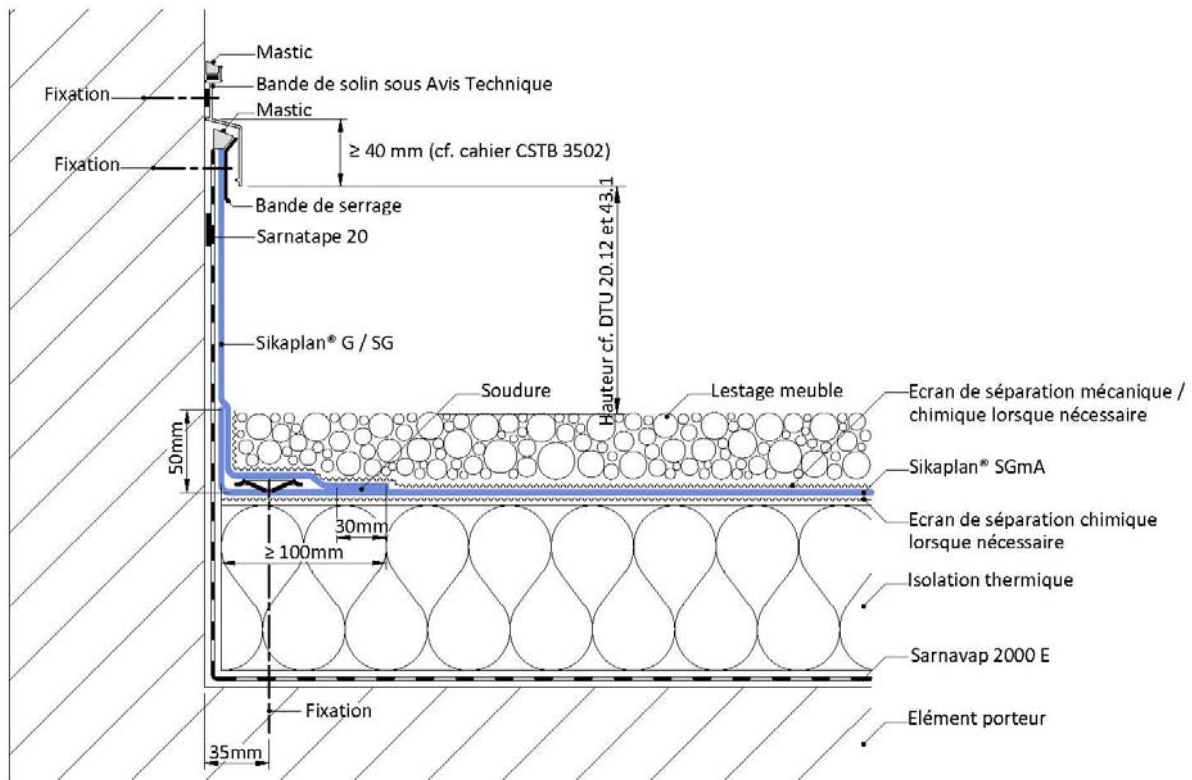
Relevé d'étanchéité avec bande de serrage sous bande soline – Travaux neufs sur maçonnerie
